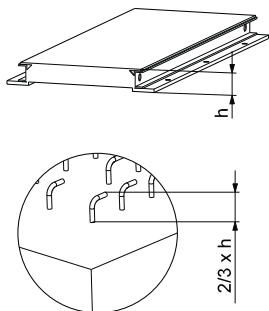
Усиливающие стальные стержни, устанавливаемые в фундамент
